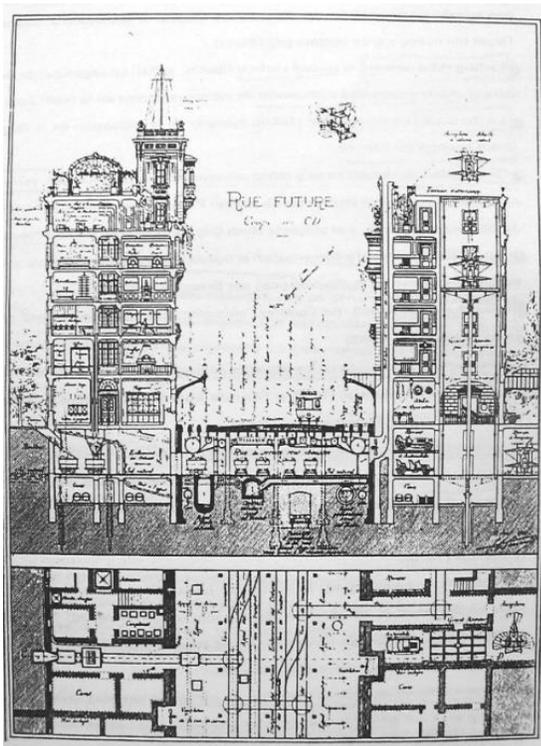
Corte de calle en la ciudad del futuro (arriba) y sección de planta (abajo), por Hénard. Fuente: Clua, 2017.
